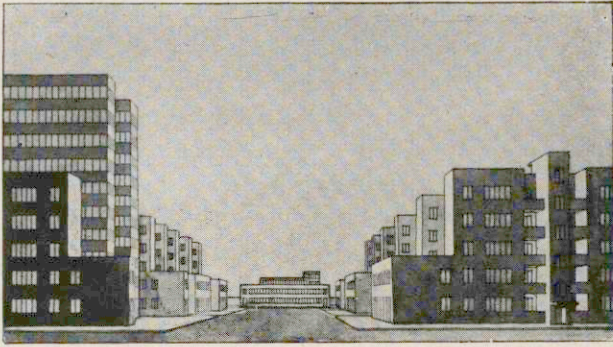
Ladenstraße einer Wohnstadt. S. Abb. 23 u. 25
